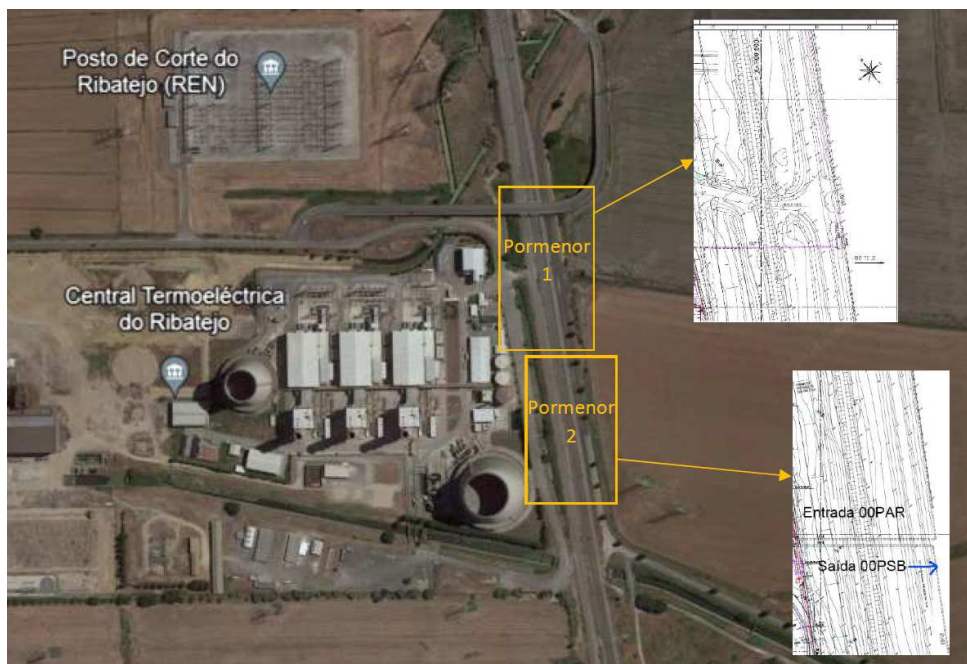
Canais de Adução e by-pass - Estrutura de proteção (ver ponto 3.2)
